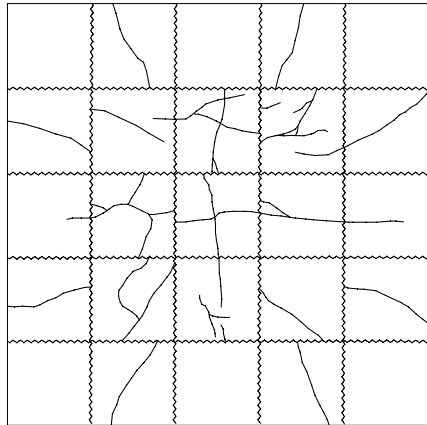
床版下面のひび割れ状態 (C24-7)
